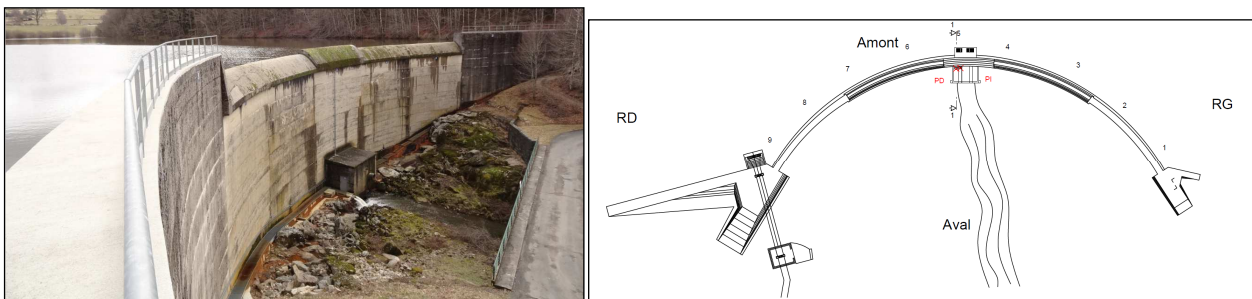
Photo du barrage des Galens (à g.) et vue en plan (à dr.)
